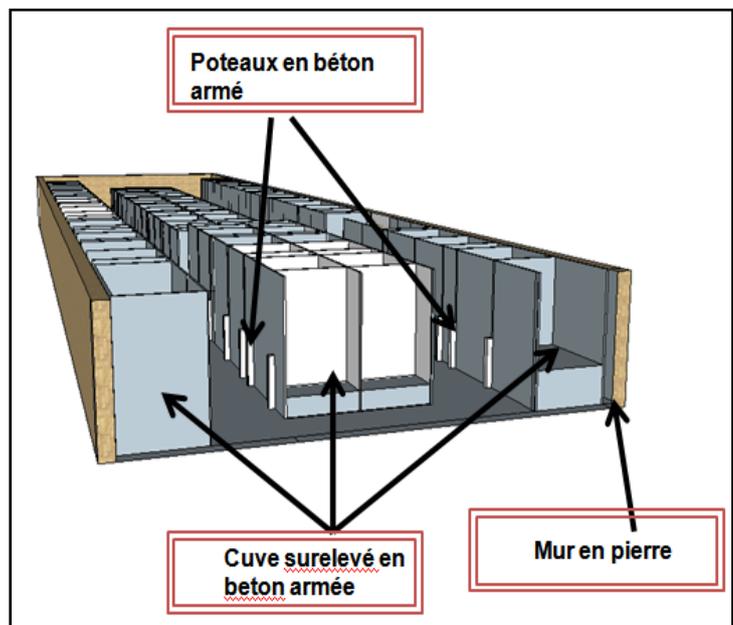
Coupe 3D sur montrant la structure du bâtiment
